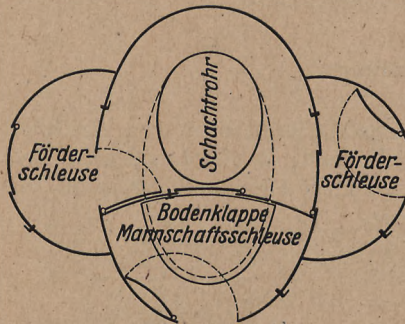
Grundriß einer dreiteiligen Luftschleuse
